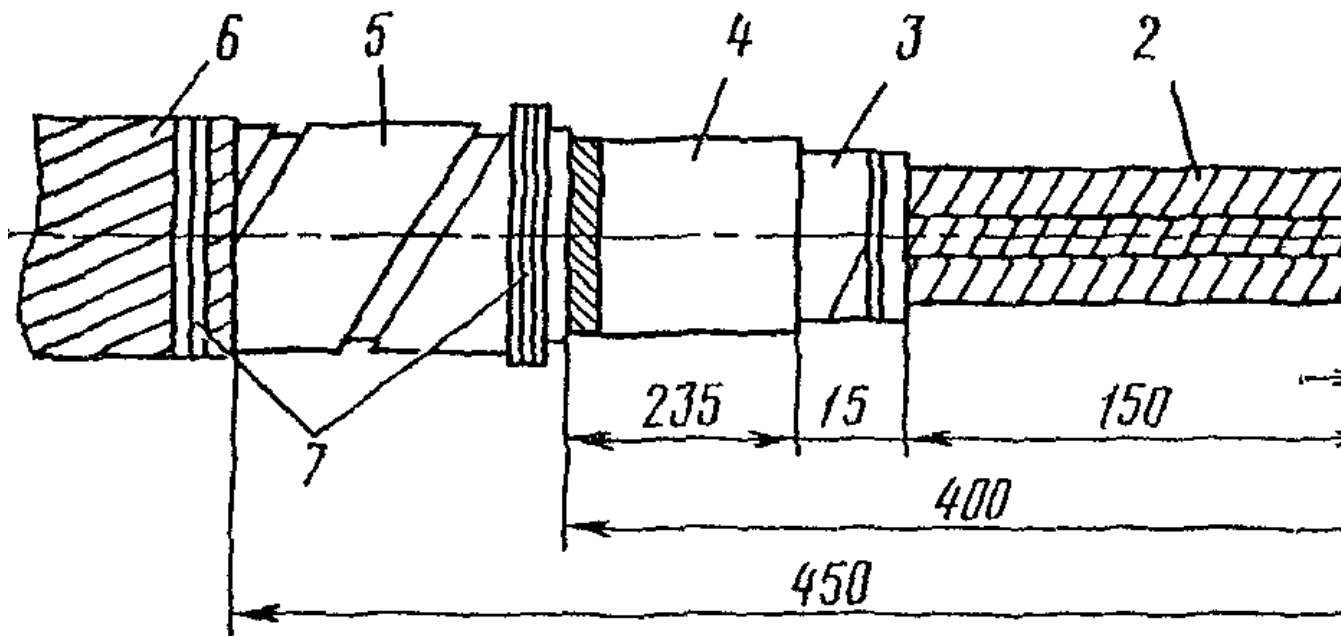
Разделка трехжильного кабеля для монтажа муфты типа И1016и: 1 - токопроводящая жила; 2 - изоляция жилы; 3 - поясная изоляция; 4 - металлическая оболочка; 5 - броня; 6 - наружный покров; 7 - бандаж
